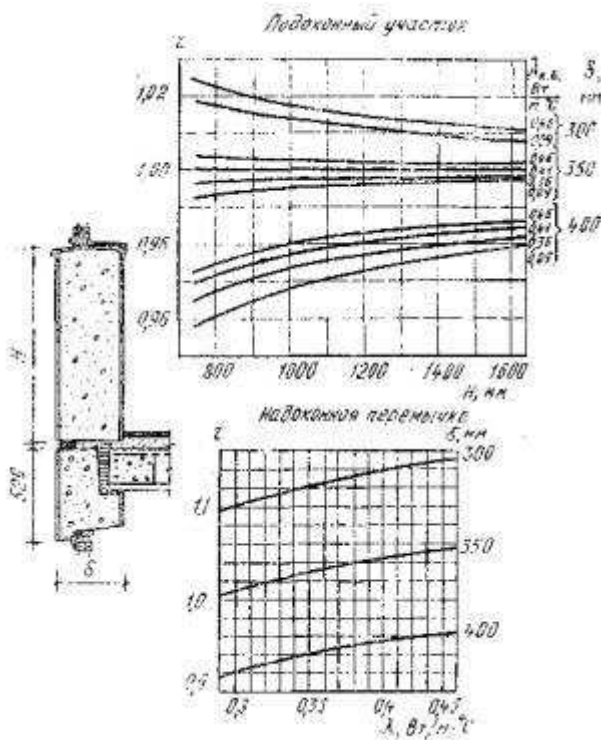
Определение r подоконного участка и надоконной перемычки стеновой панели с утепленным горизонтальным стыком, при спаренных оконных блоках (с плитой перекрытия $\delta n = 220$ мм)
